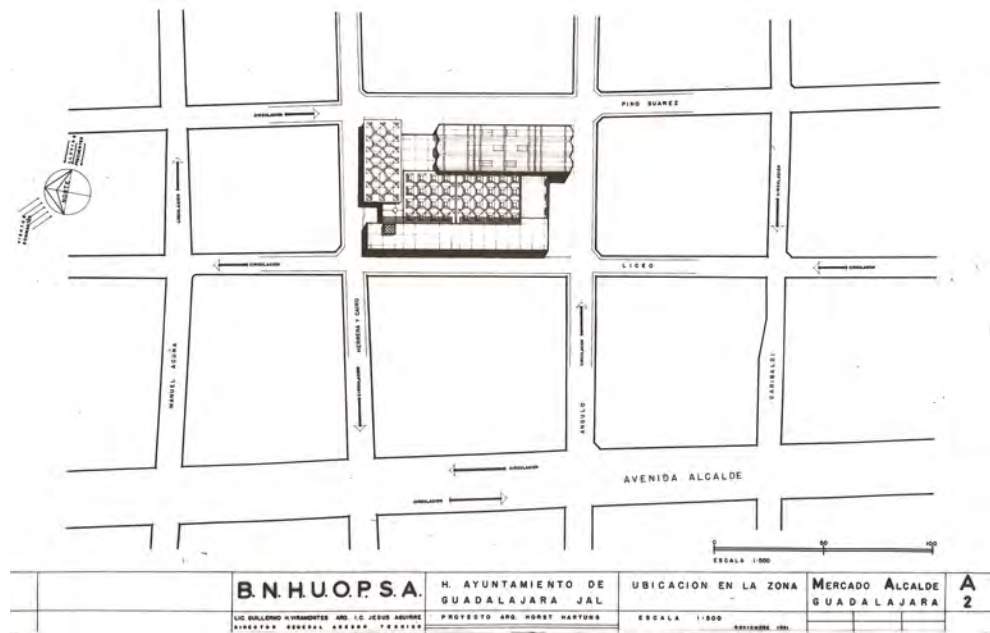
Mercado Alcalde, Lageplan (Ubicacion en la Zona)
